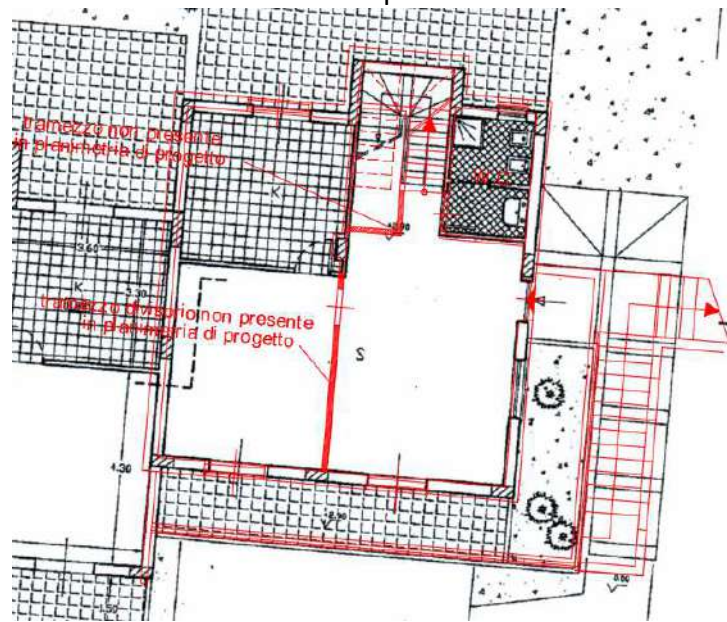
Sovrapposizione della planimetrie di rilievo di piano terra con la corrispettiva planimetria allegata alla Concessione edilizia
